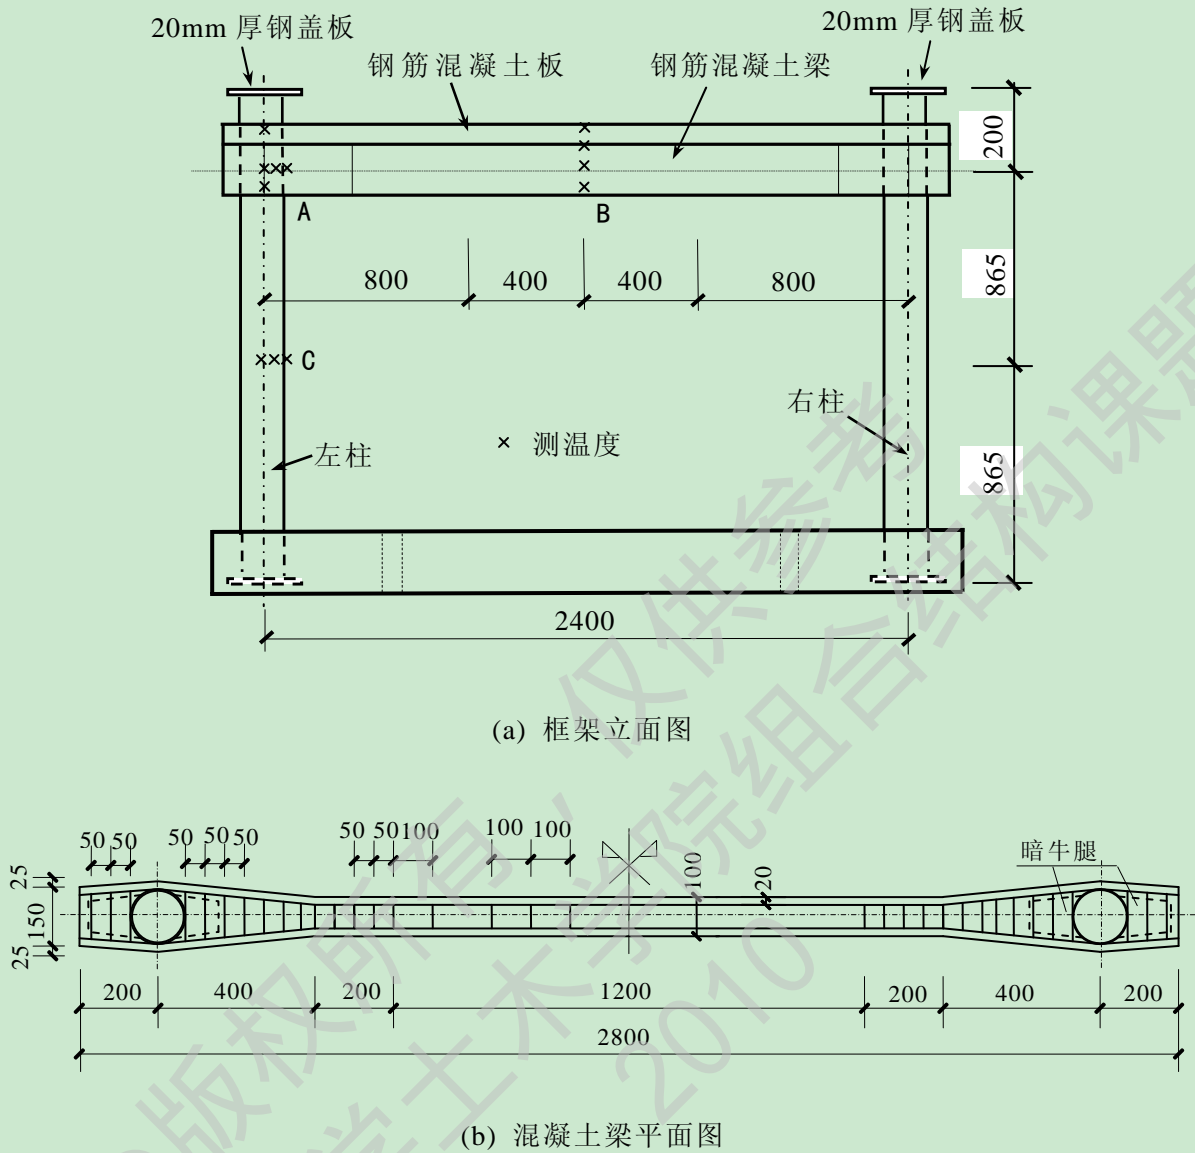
圆钢管混凝土柱-钢筋混凝土梁框架尺寸图 (王卫华, 2009^[51])
